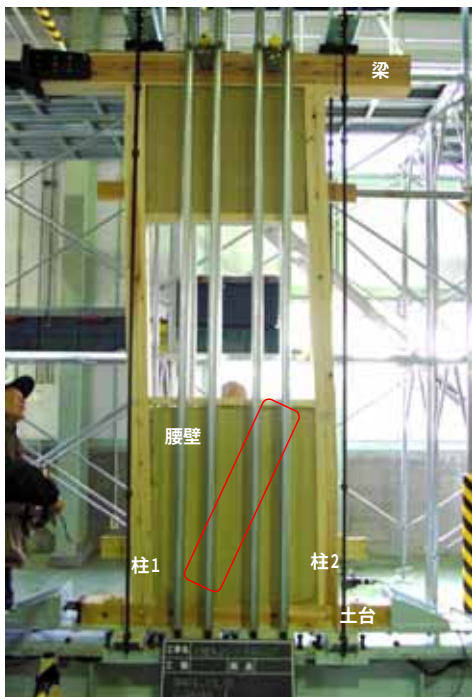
中塗側 1/50rad 窓敷居・柱周りのひび割れ
